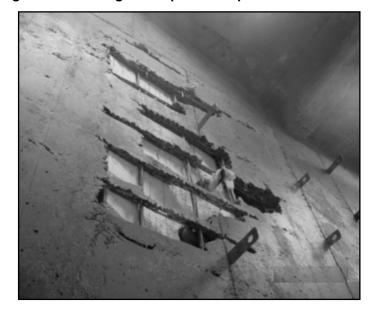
Pared agrietada por mala aplicación de concreto
